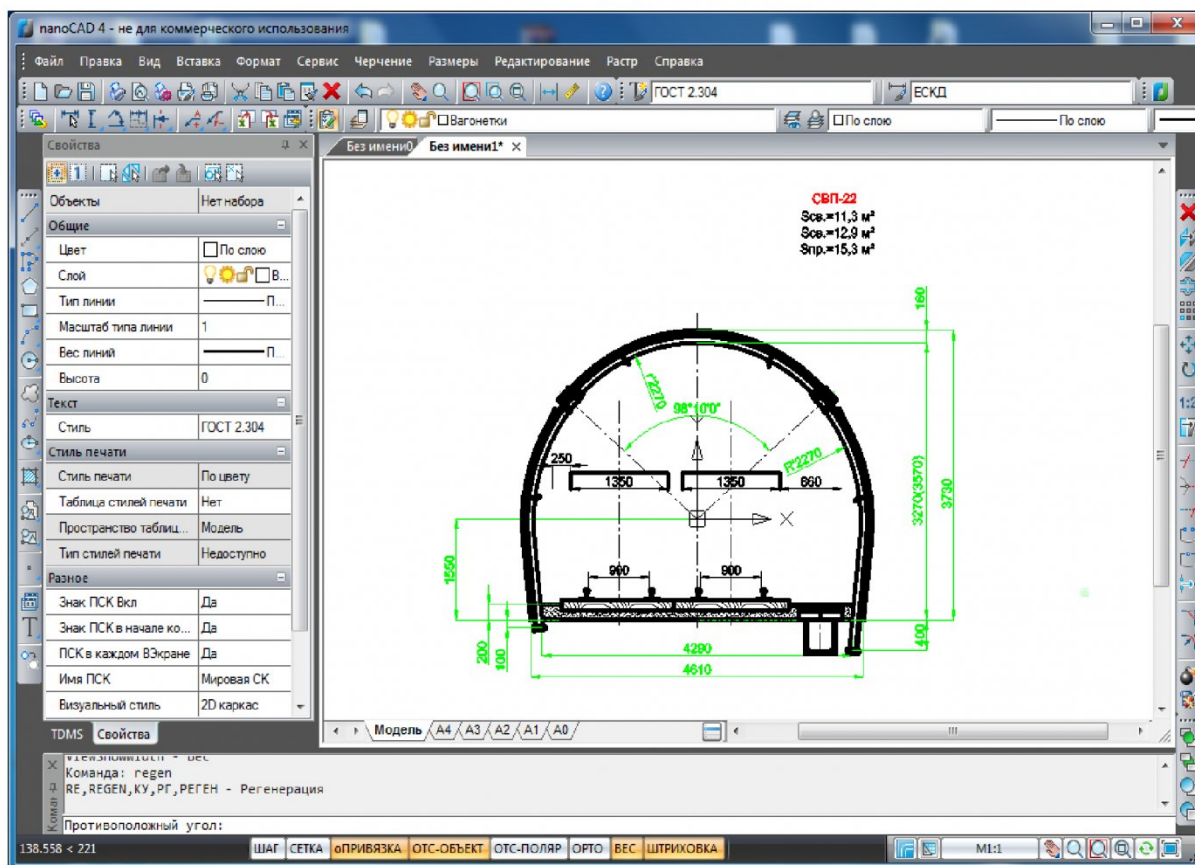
Вывод предлагаемого чертежа паспорта арочной крепи
